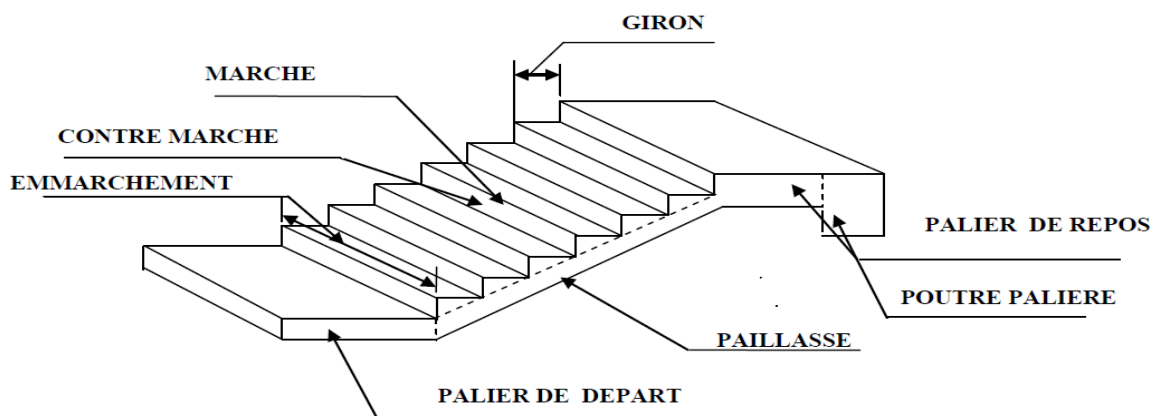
Schéma général d'une volée d'un escalier droit.
